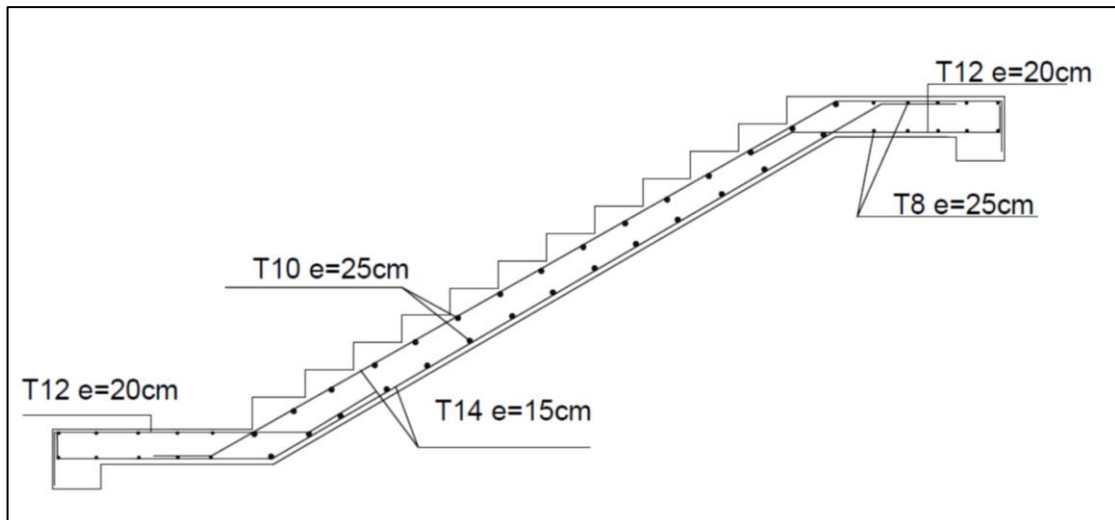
Schéma de ferrailage de l'escalier de RDC.
